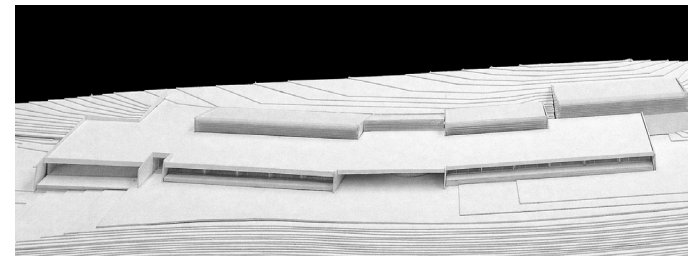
Imagen desde la zona cubierta del patio. RCR architects, 2010.
